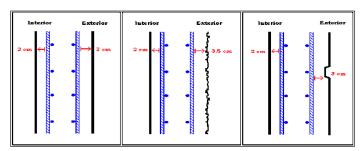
Detalle de armaduras en hormigón a la vista con acabado liso, hormigón a la vista puntereado y hormigón arquitectónico en el último caso
